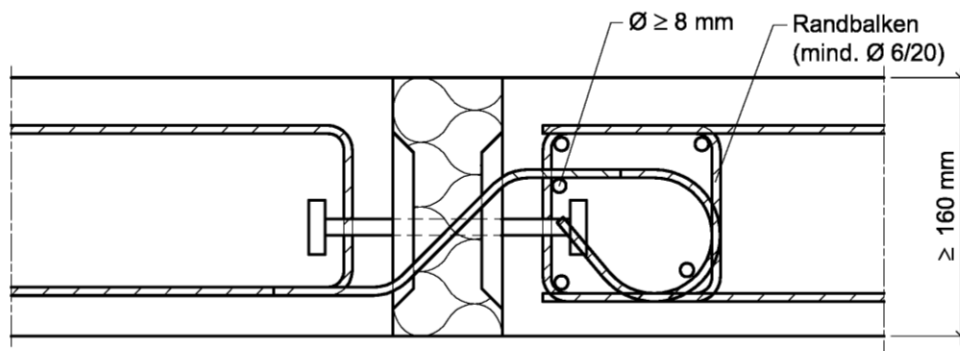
Beispiel Schöck Isokorb® Typ Q mit Vertikalbewehrung
